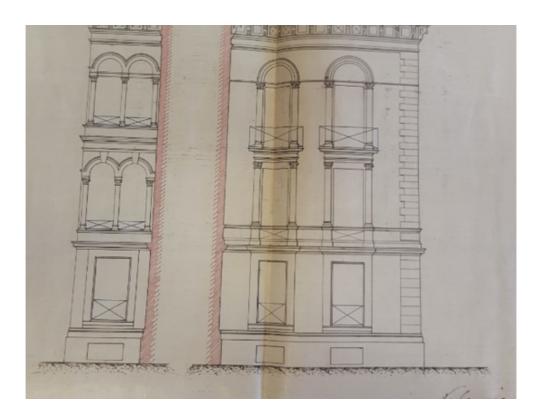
Planos de la fachada. Fuente: Archivo histórico
